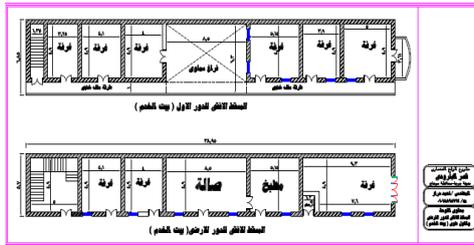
مسقط أفقي للدور الأرضي للقصر .
